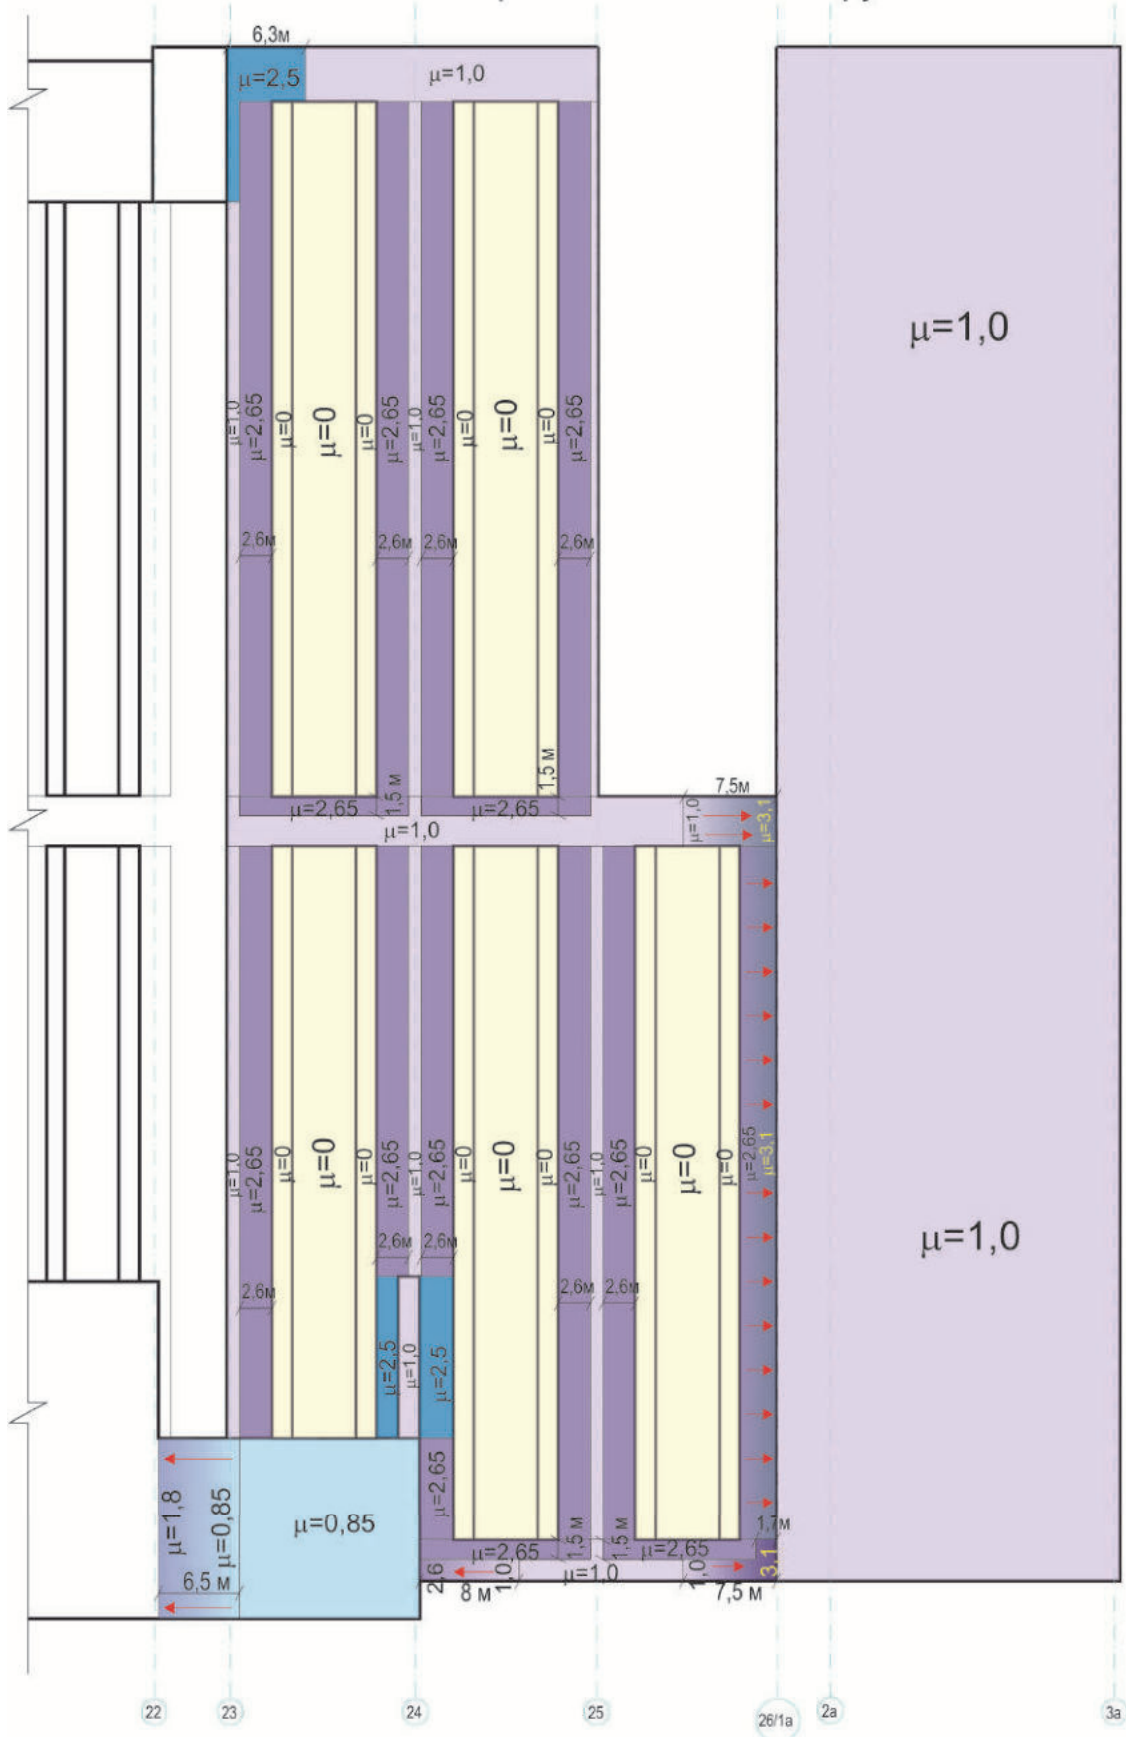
2-ой вариант покрытия. Снеговые нагрузки. Вариант 2
